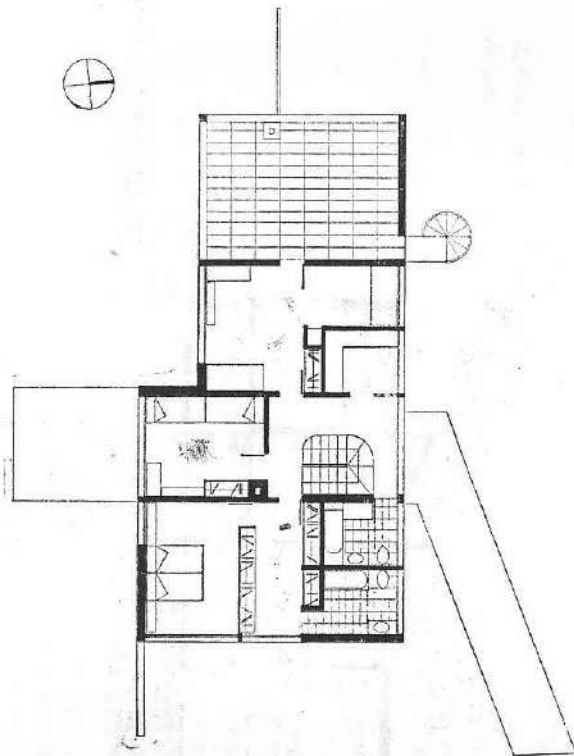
Walter Gropius: Casa en Lincoln, Mass. Planta alta.
